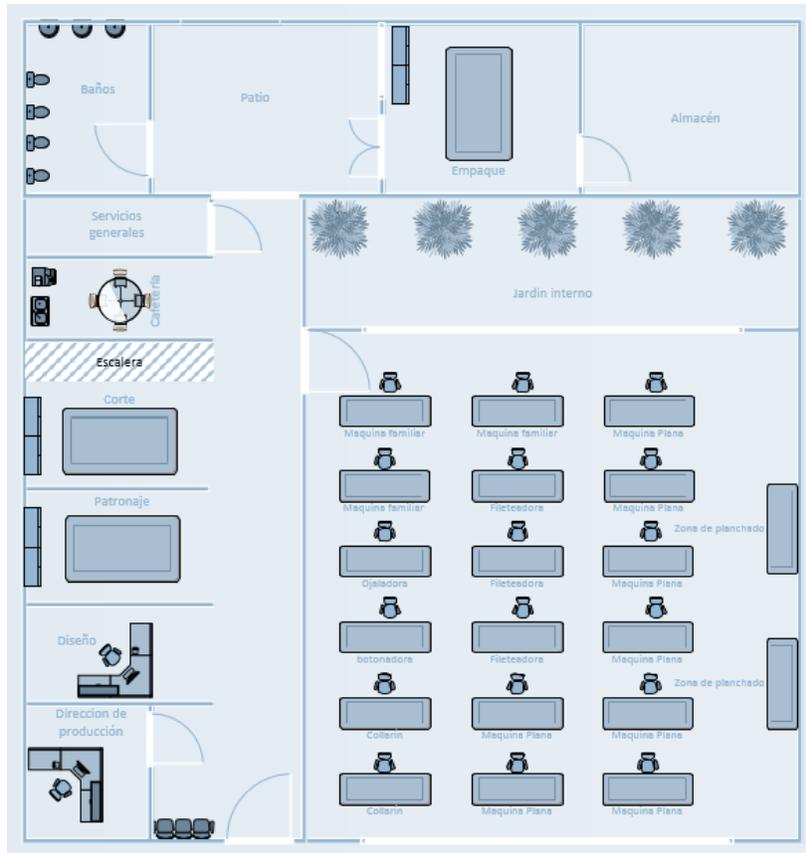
Plano fabrica AMEDIDA – Primer piso. Fuente: construcción de los autores.
